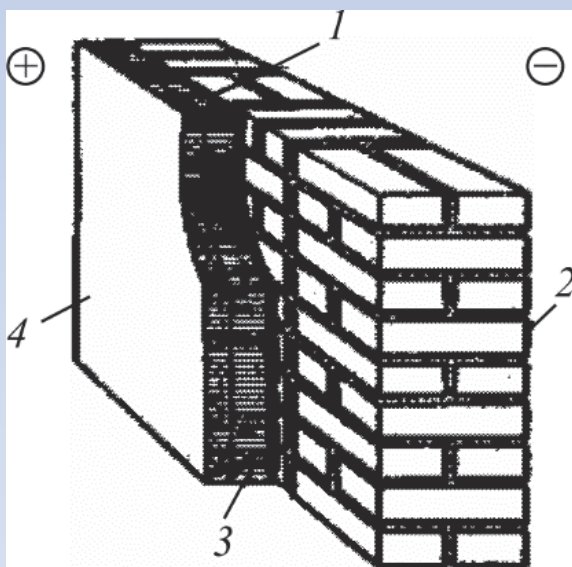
Теплоизоляционный элемент из гипсовой плиты и полиуретановой теплоизоляции: 1 – однокомпонентная полиуретановая вспенивающаяся композиция; 2 – утепляемая стена здания; 3 – теплоизоляционный слой из полиуретана; 4 – гипсовая плита
